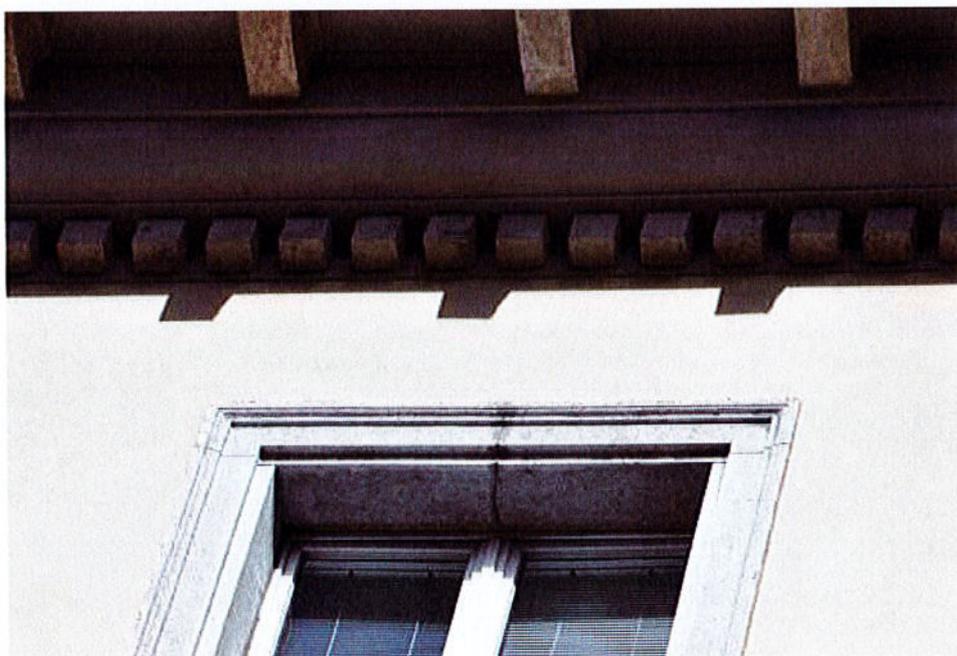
stuccature mancanti nella cornice sottofinestra e fessurazioni passanti sull'architrave, ultimo piano
